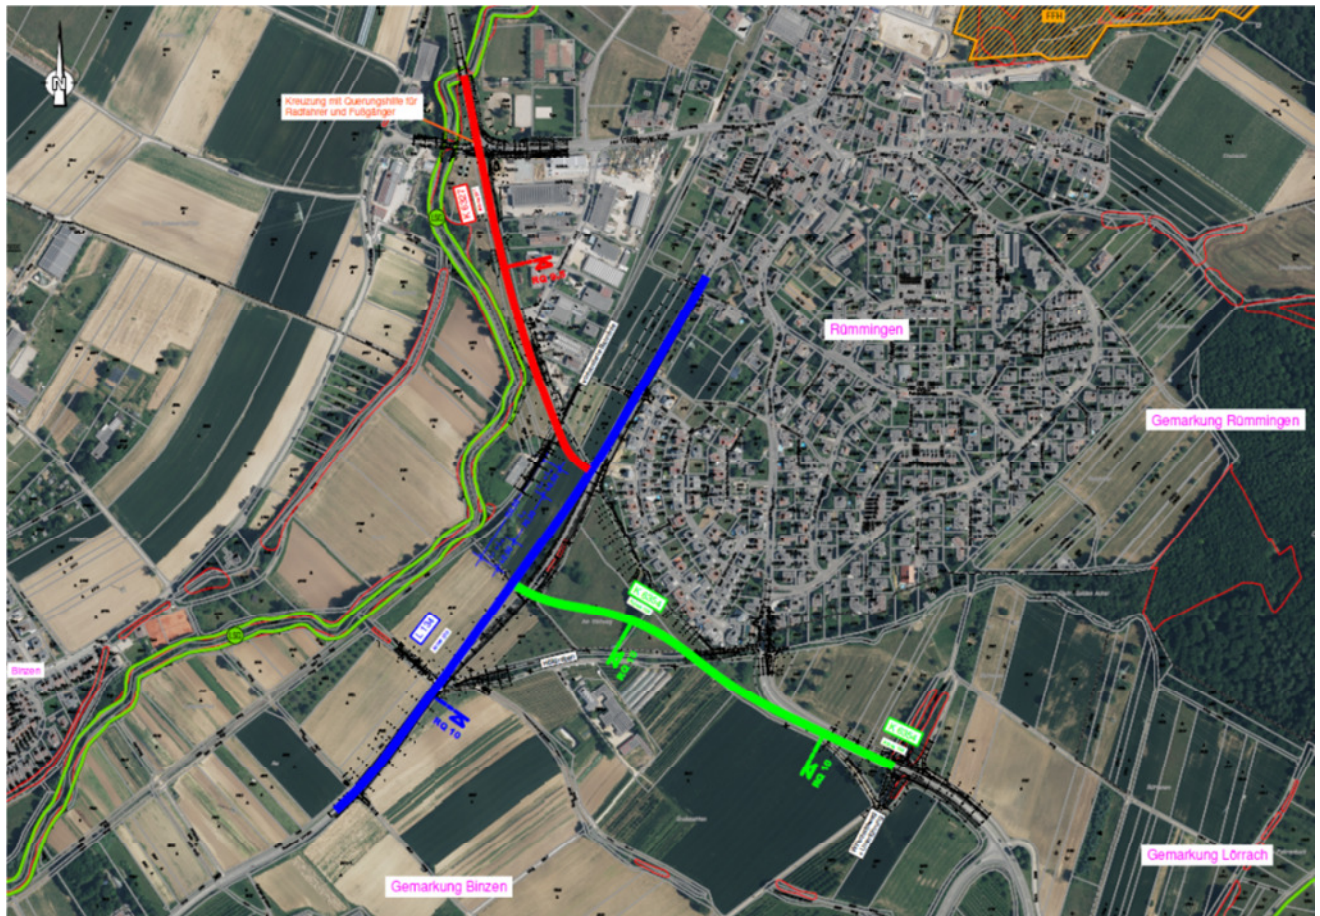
Übersichtslageplan – Linienführung Planfall 2
